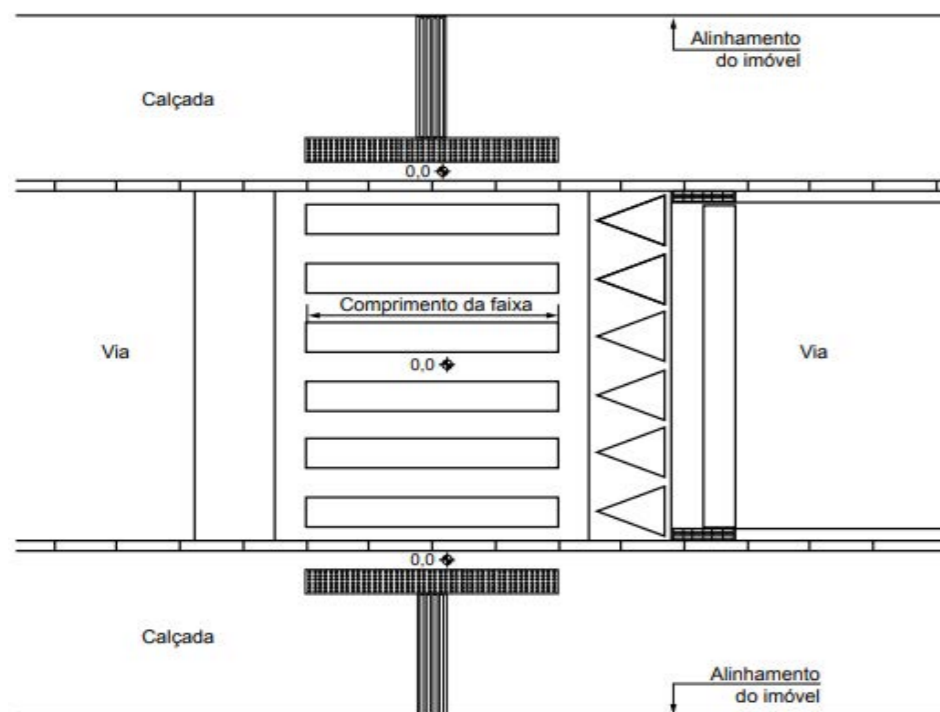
Faixa elevada para travessia - Exemplo - Vista superior
